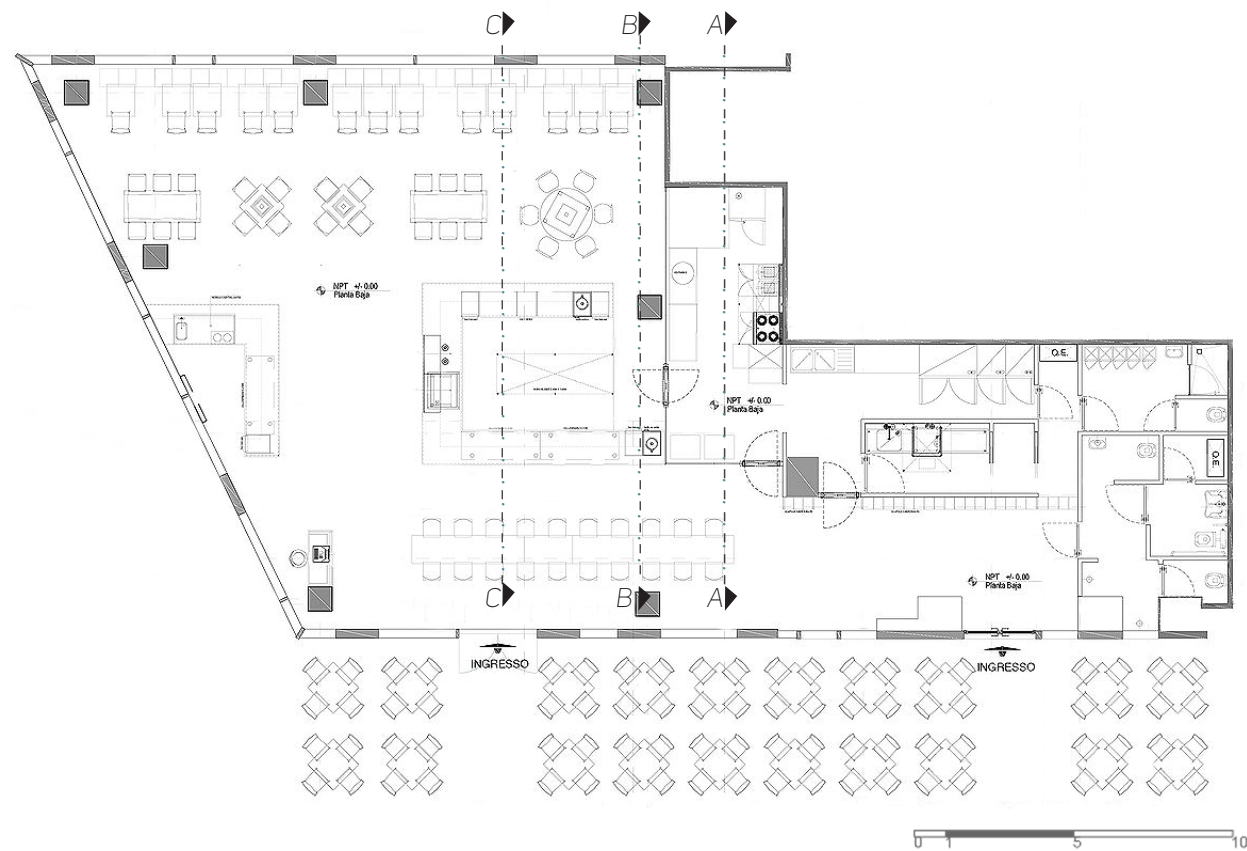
Planta Baja Bésame Mucho Restaurante. Recuperado de ArchDaily, 2016
